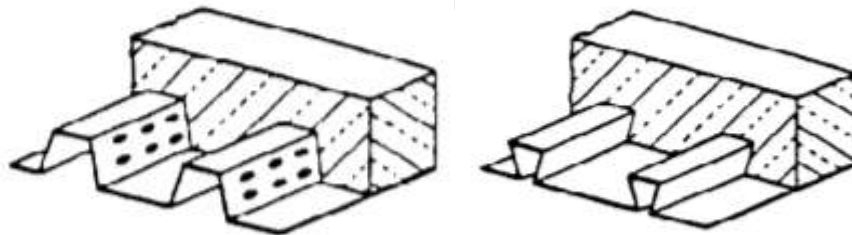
Ejemplos de engarce mecánico y ángulos agudos (hormigón y perfil de acero)
